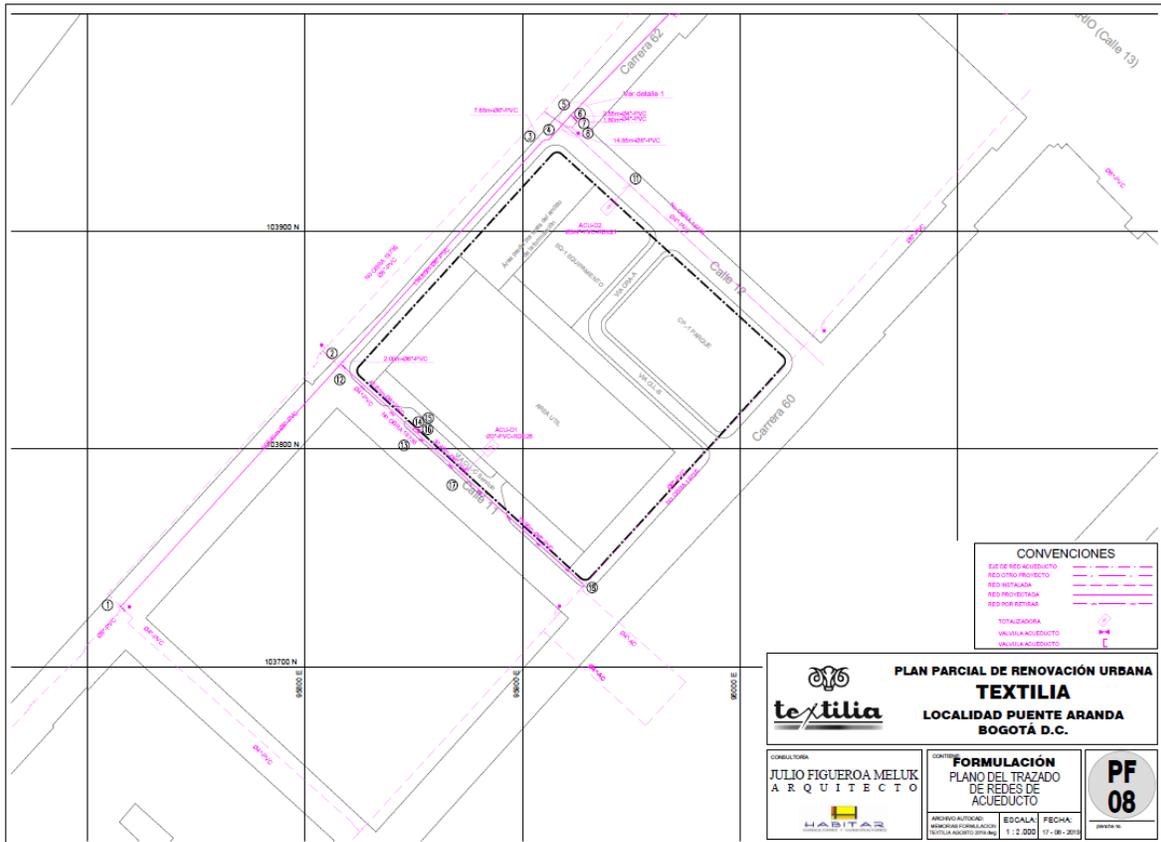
Plano PF-08. Trazado de Redes de Acueducto
